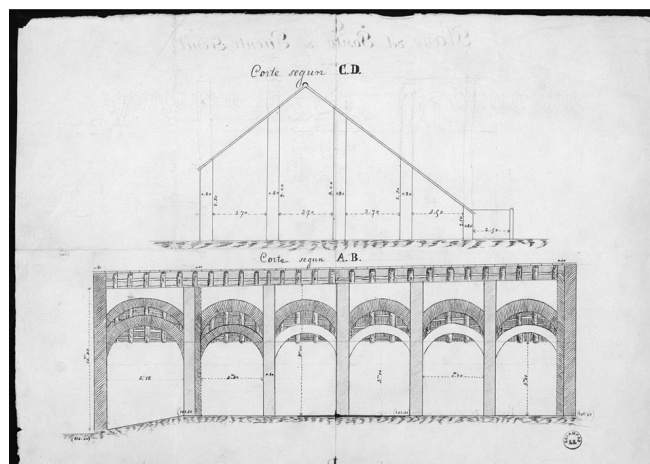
Alzado del pósito de la calle Ancha, 17. Fuente: Biblioteca Nacional de España.
